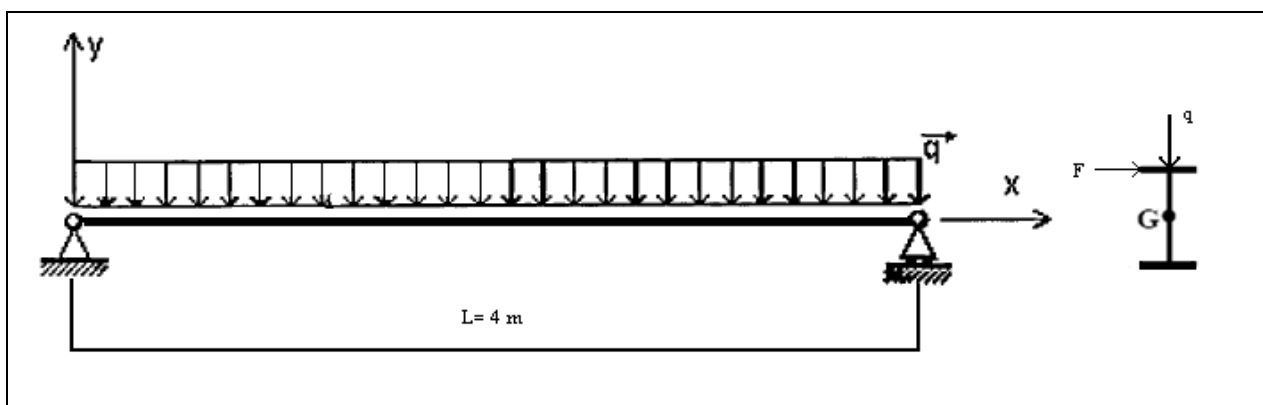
Schéma statique de la poutre PFS d'un pont bipoutre
